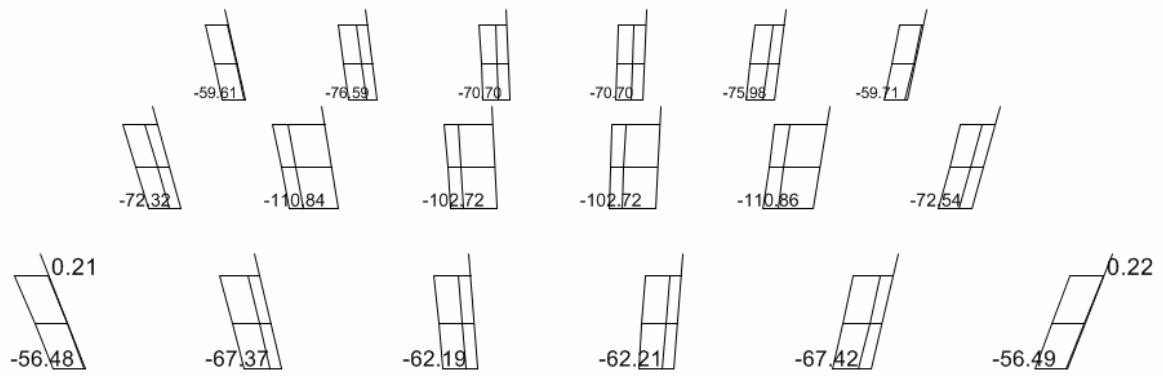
Se muestran las cargas axiales de la planta baja..
